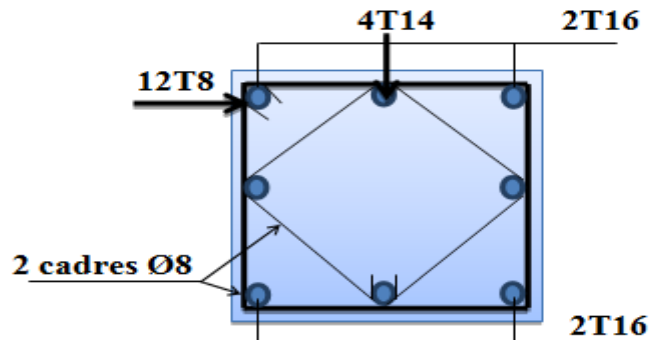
Schéma de ferrailage des poteaux (35×45).
